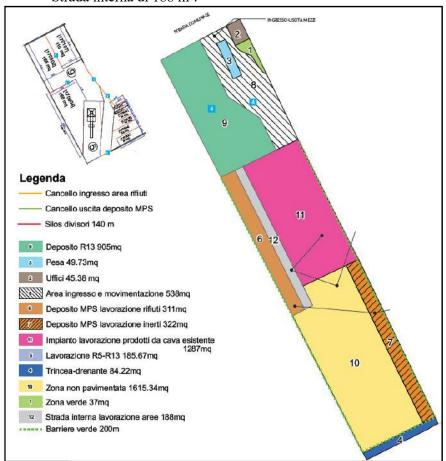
Planimetria con organizzazione esistenti e di rifunzionalizzazione.
